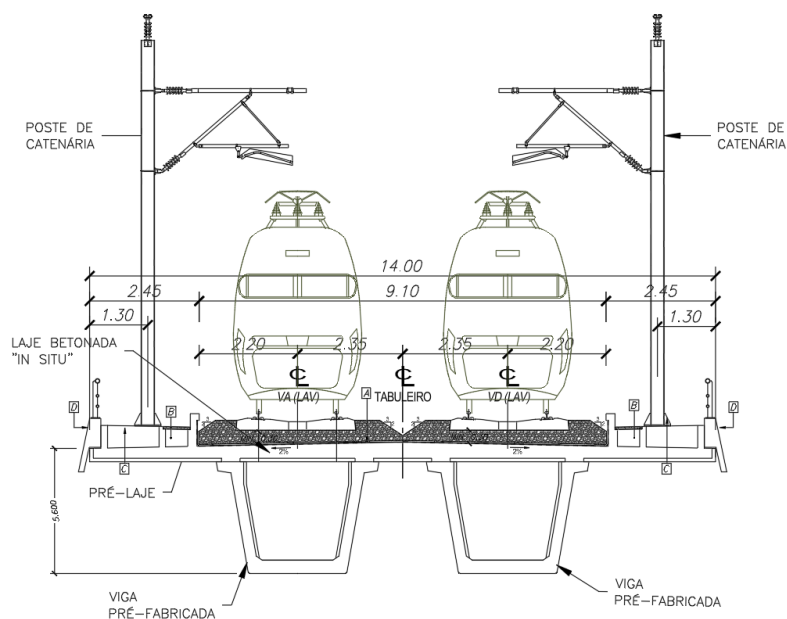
Pontes/Viadutos LAV- Via balastrada em reta
